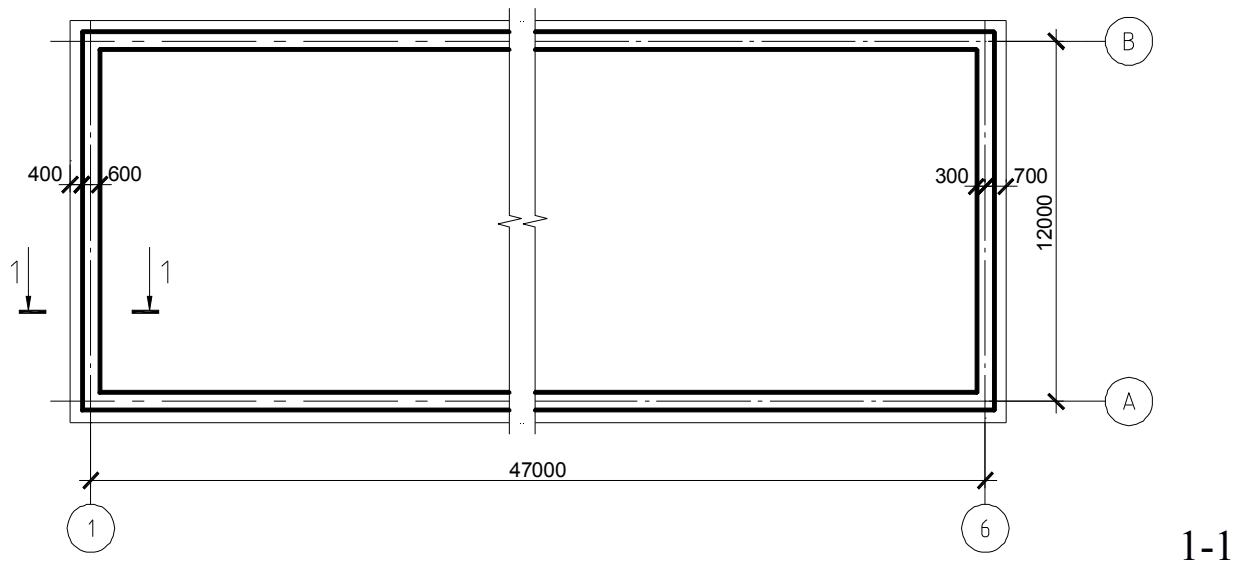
Схема стрічкового фундаменту реконструюється житлового будинку
